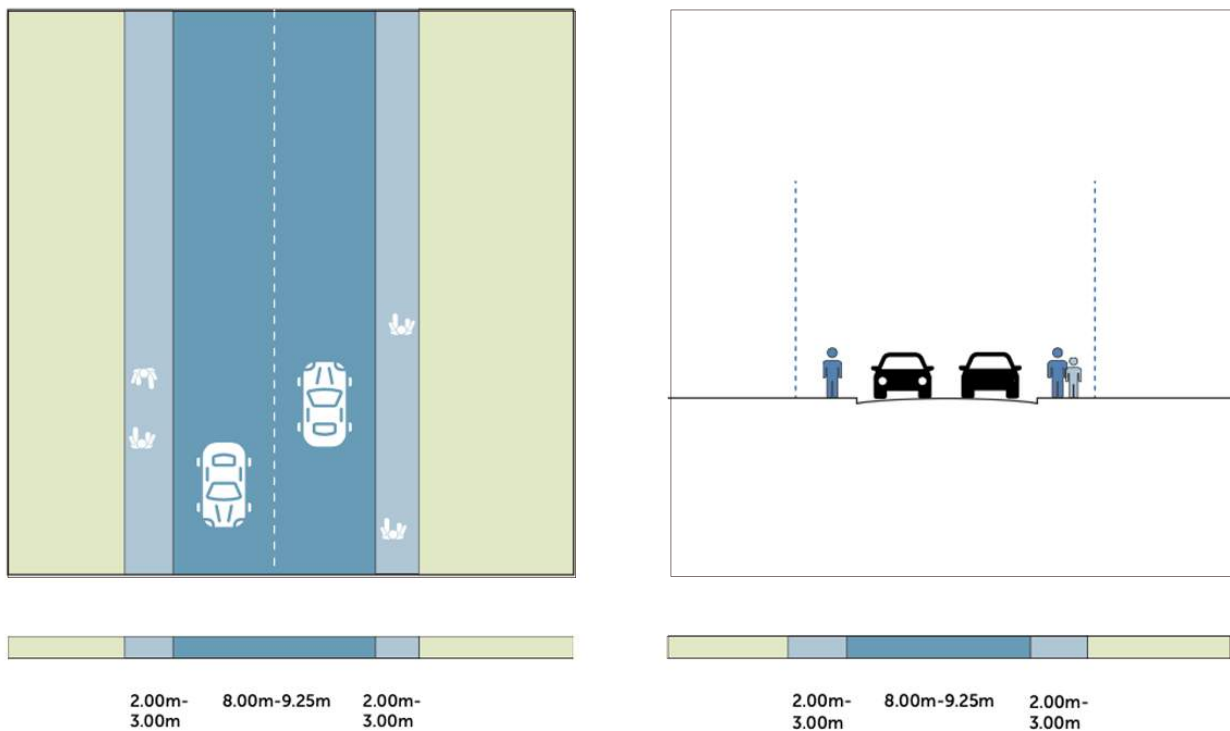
Str. Constantin Bobescu: reprezentare în plan și secțiune transversală. sursă: autor
